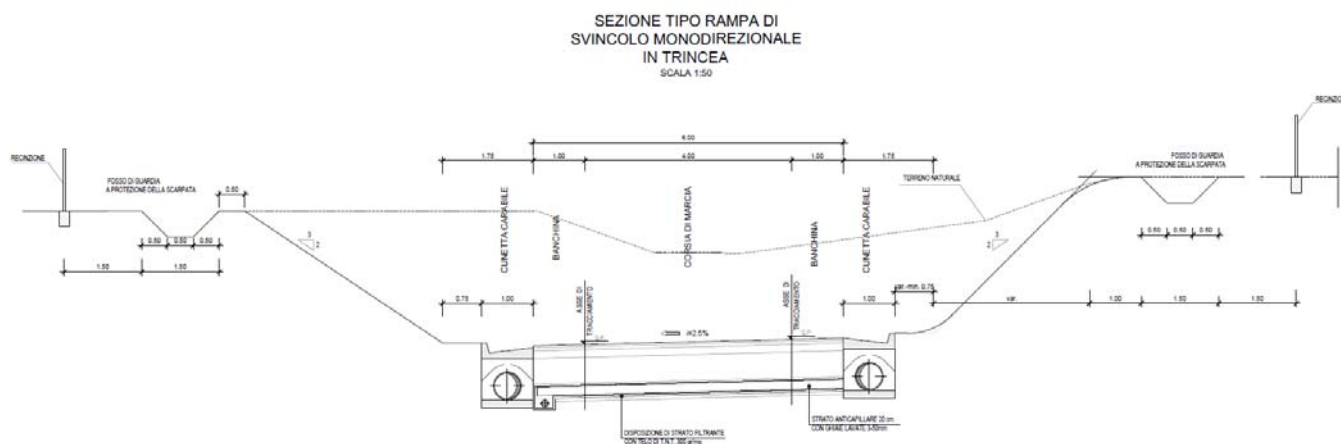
Sezione tipo in trincea rampa di svincolo
